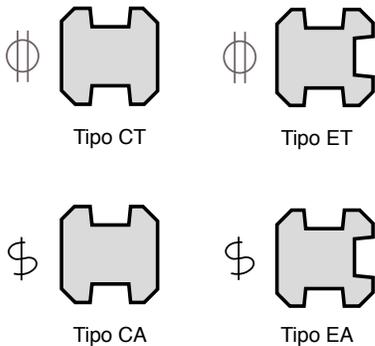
Detalle de los tipos de columna del sistema Prefa Holcim
